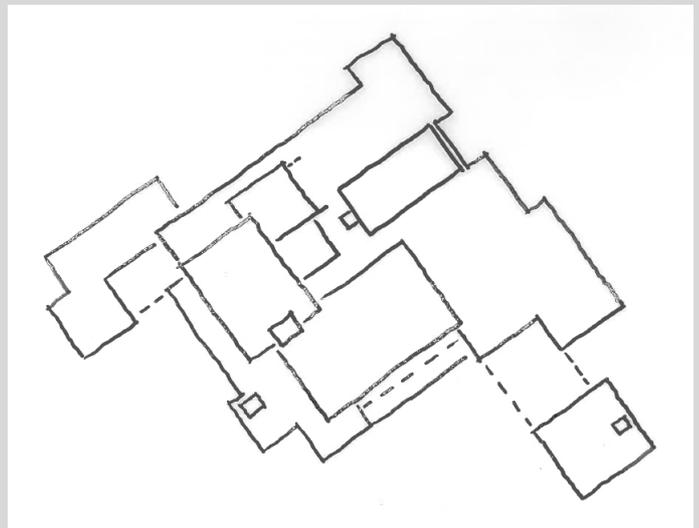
Gemeinschaftshaus Langwasser - Lageplan
